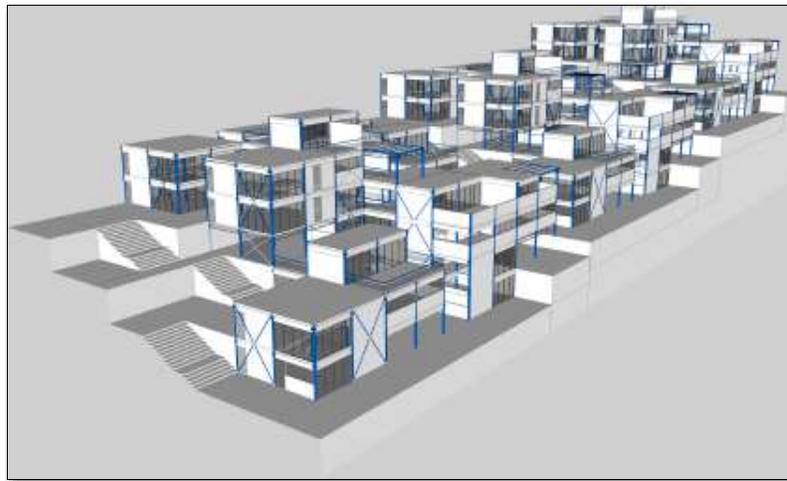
Conjunto Tipo 2. Fuente: Mendoza, Luis.
